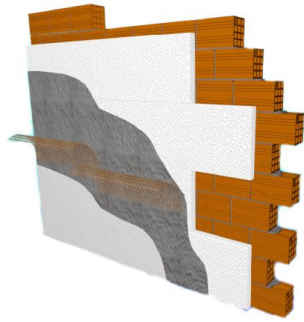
Parede com Isolamento Exterior. ©Dryvit
